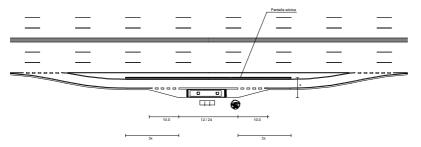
PROTECCIÓN ACÚSTICA DE PARADAS DE AUTOBÚS SOBRE AUTOPISTAS O AUTOVÍAS
